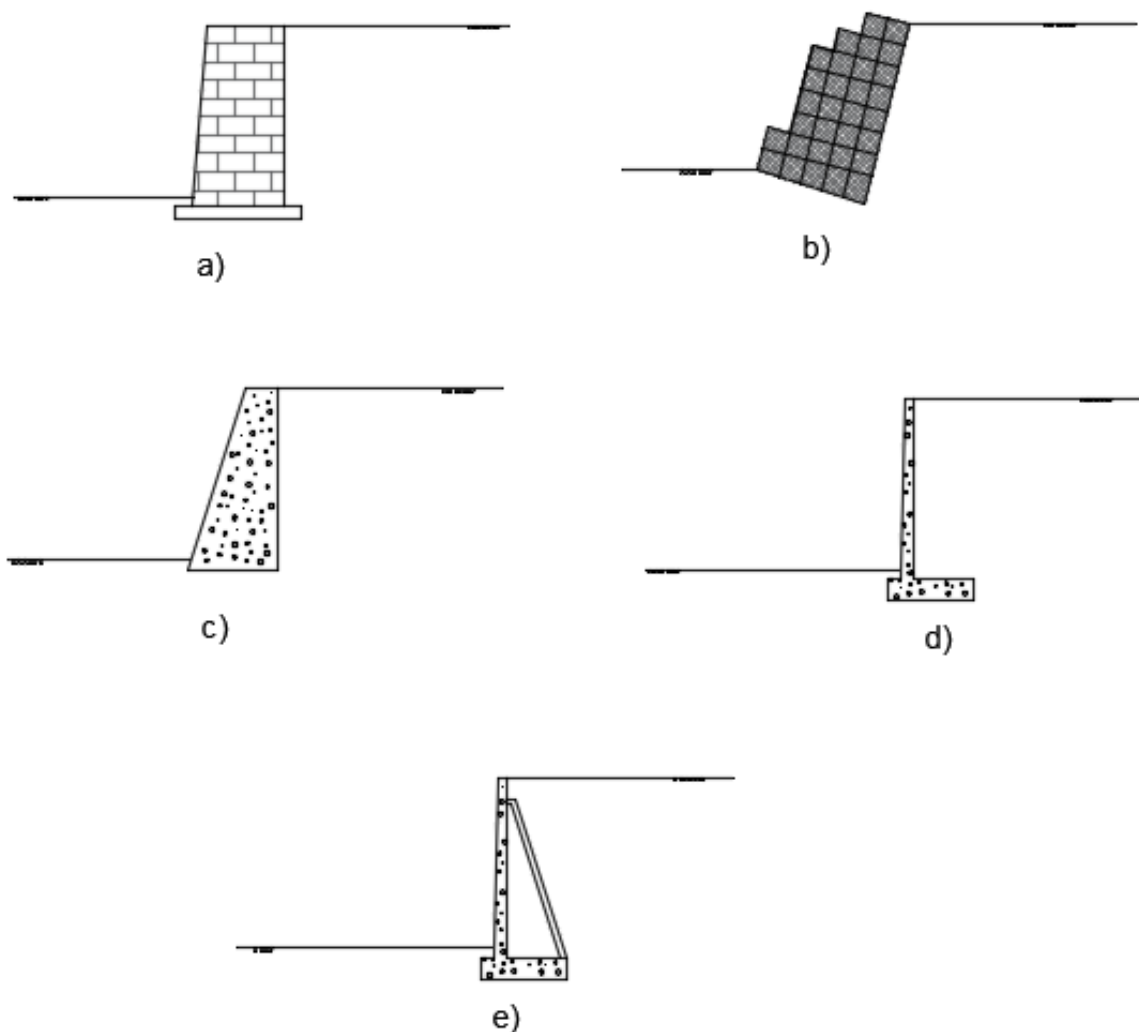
Diferentes tipologias de muros de gravidade: a) muro em alvenaria; b) muro de gabiões; c) muro de betão ciclópico; d) muro de betão armado; e) muro de betão armado com contrafortes (Fernandes, 2011, adaptado).
